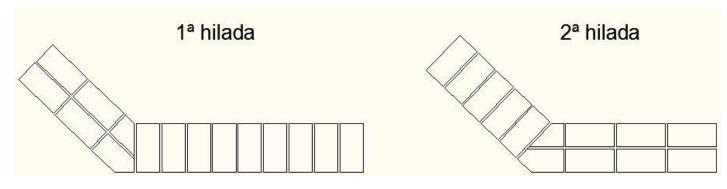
Encuentro del muro en la zona de chaflán. Elaboración propia
